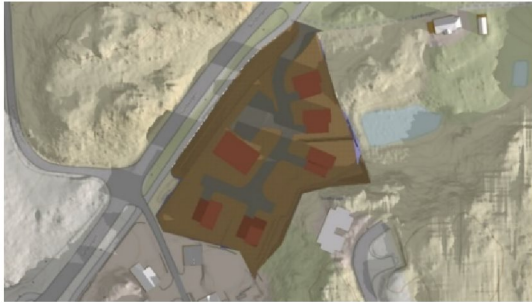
Plan skisse, av mulighetsvurdering Sundvegen boliger.
